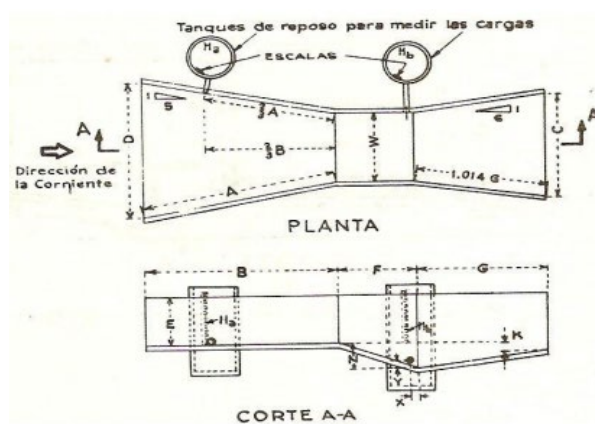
Planta, elevación y dimensiones de un medidor Parshall. (Tomado de (Ruíz, P. R., 2008, Hidráulica de canales pág. 196)).
